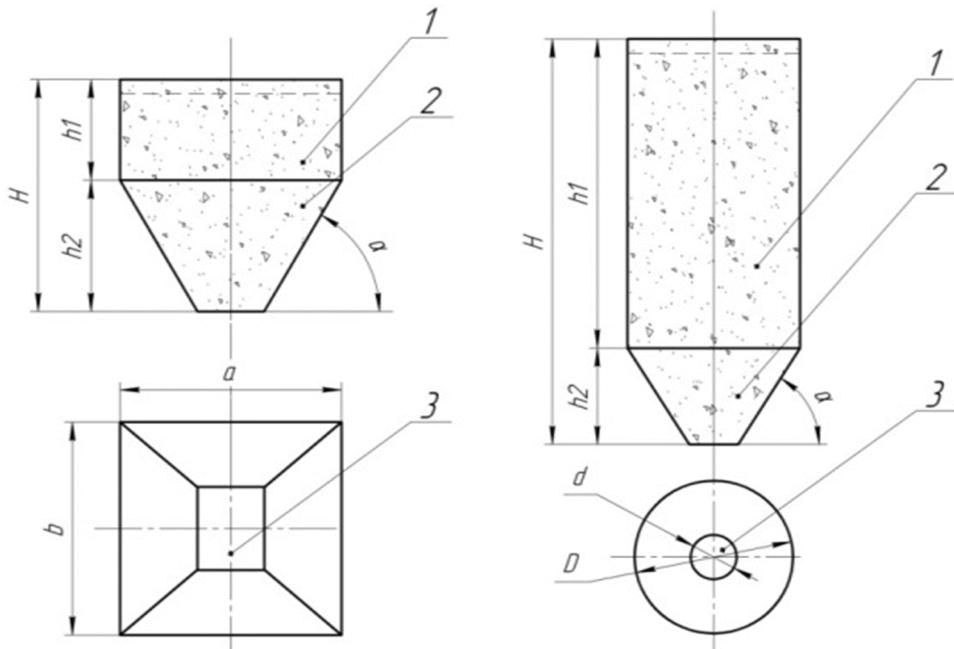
Схемы прямоугольного бункера и круглого силоса
